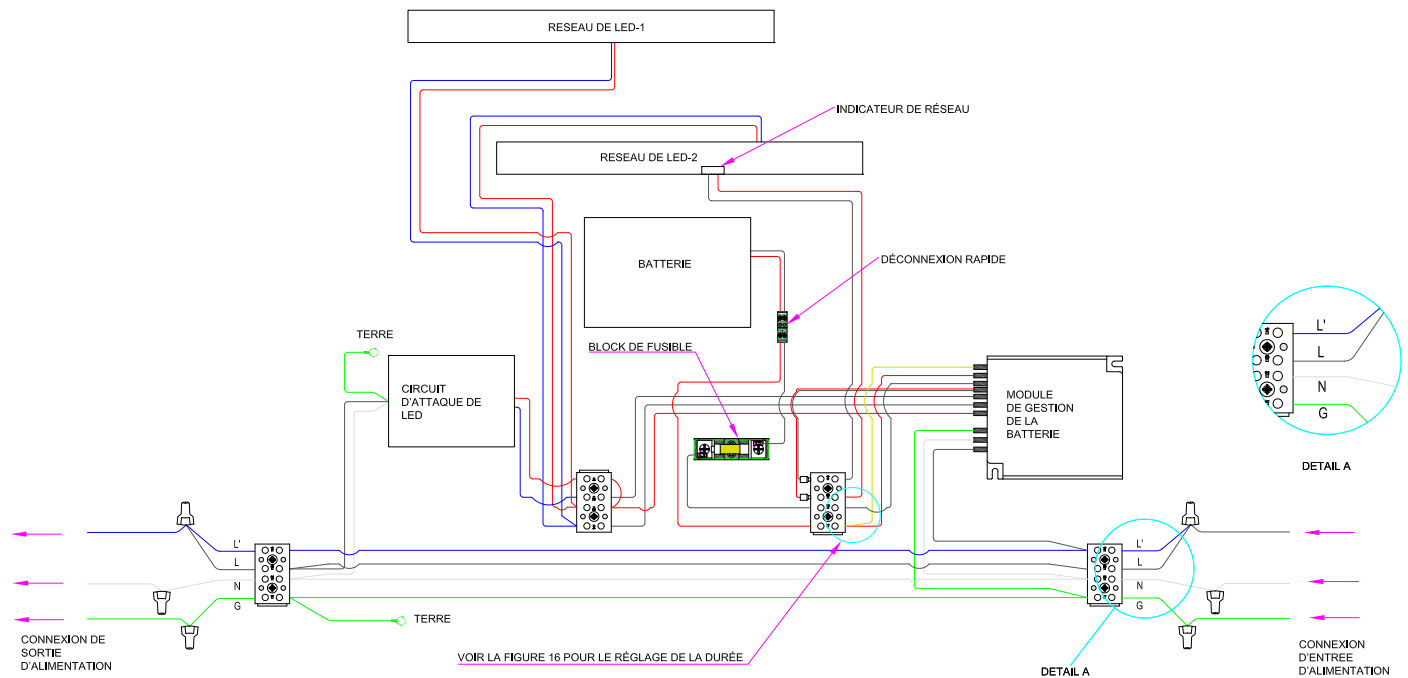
D: CABLAGE D'ALIMENTATION CONTINUE, DISPOSITION DE CONNEXION A 3 FILS AVEC ECROUS DE FIL: 4 PIEDS
